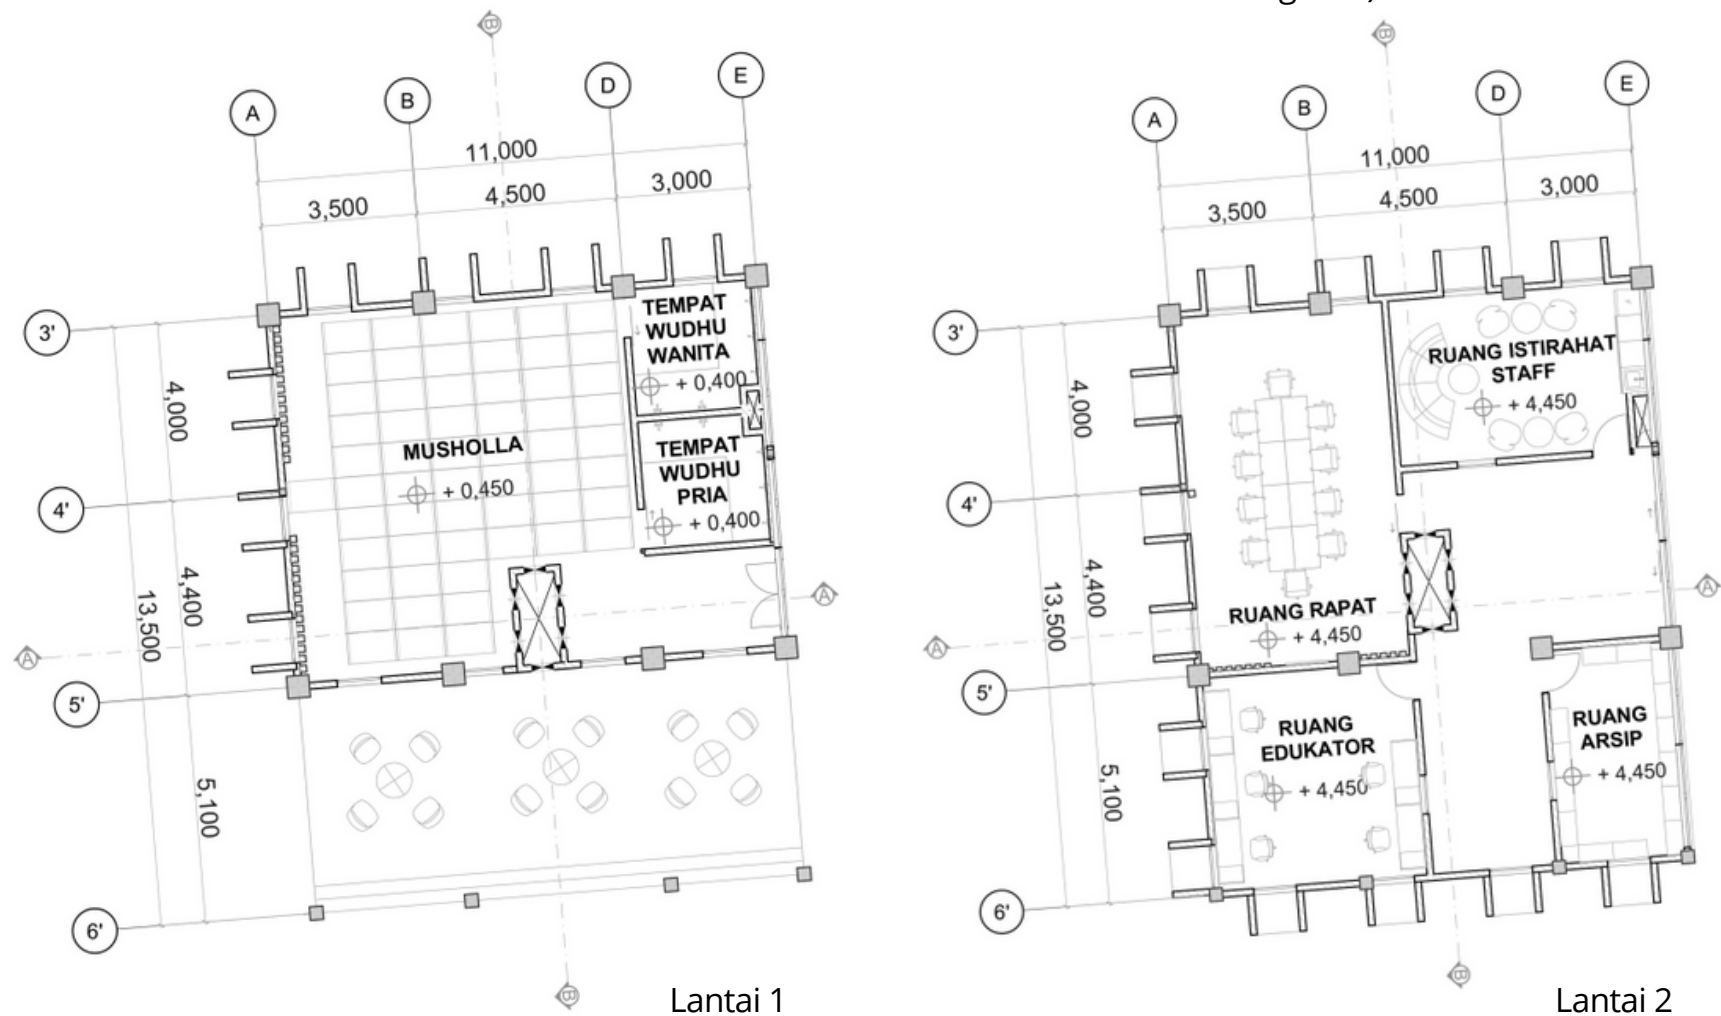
Denah Lantai 2 Galeri Kerajinan Pekalongan
